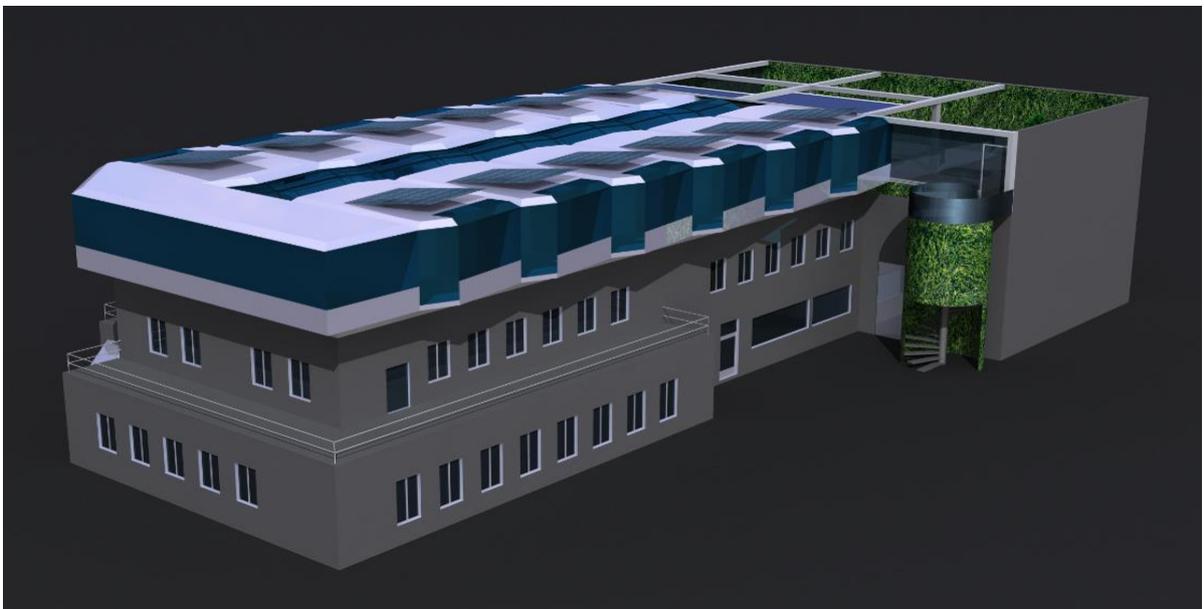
Dimension und Maße 12 Stück Containerversion 16012017 Stiegen Ansicht Hinterer Teil Einfahrt Helios
